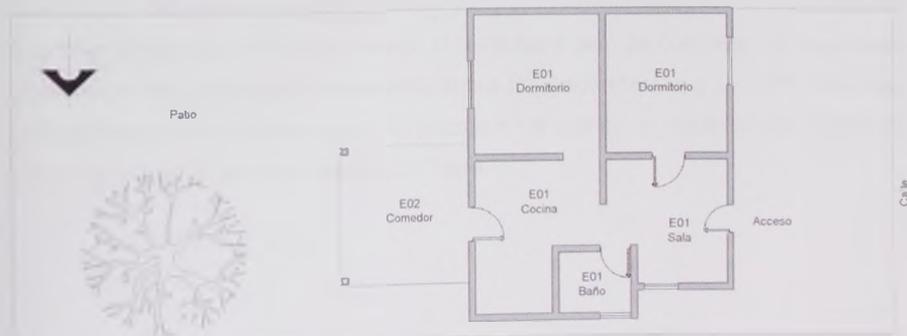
Materiales de construcción de una vivienda C2 tipo "a".
